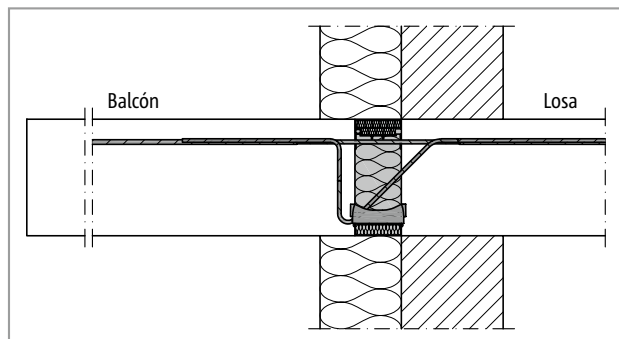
Schöck Isokorb® T tipo K: Conexión para sistema de aislamiento térmico exterior (SATE)
